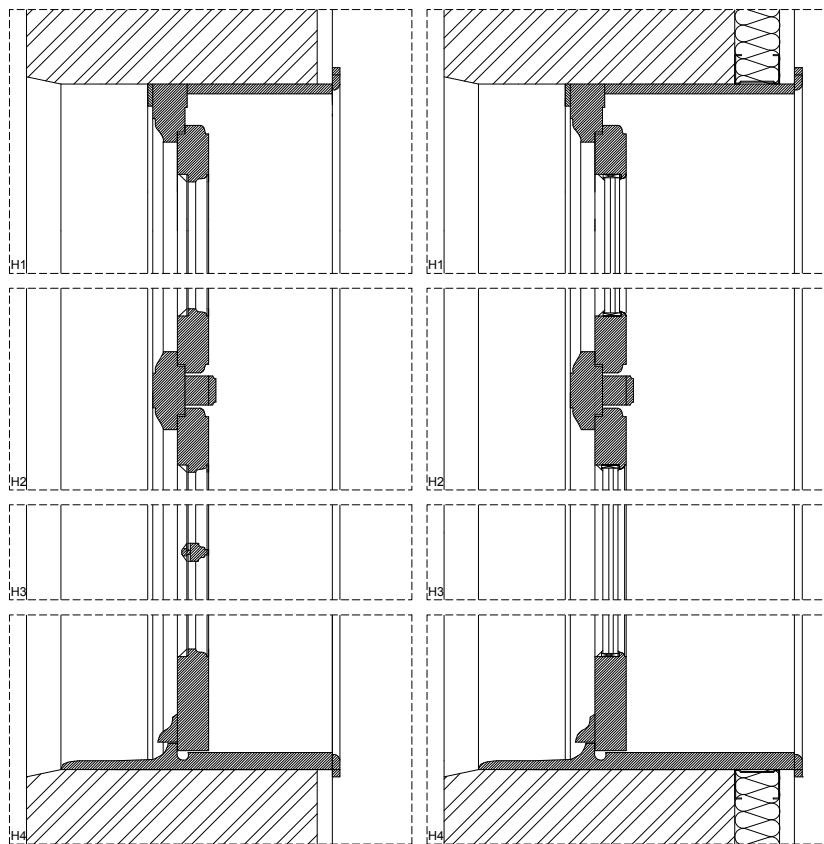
VE2 | Levantamento e proposta | Corte | Escala 1.10
